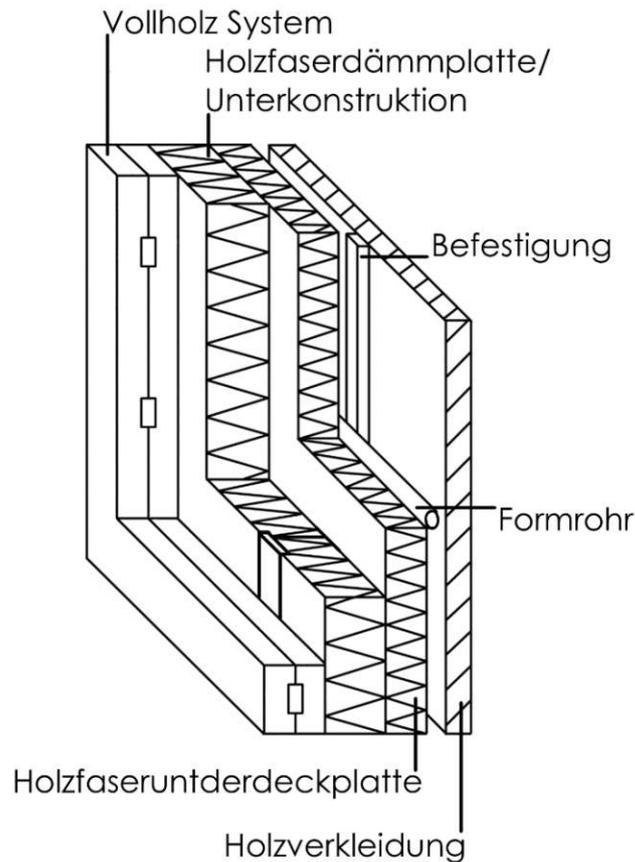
eigens erstelltes Bauteil mit Hilfe des Bau-book Bauteilrechners [8]
